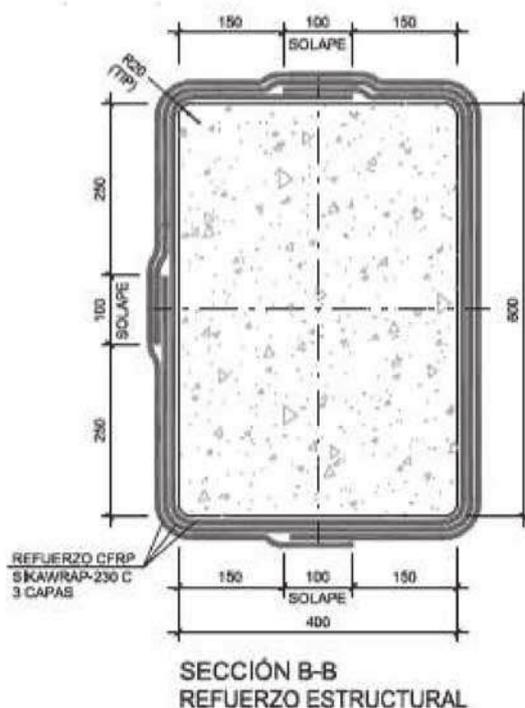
Refuerzo en pilares. Fuente: Acciona Ingeniería S.A.
